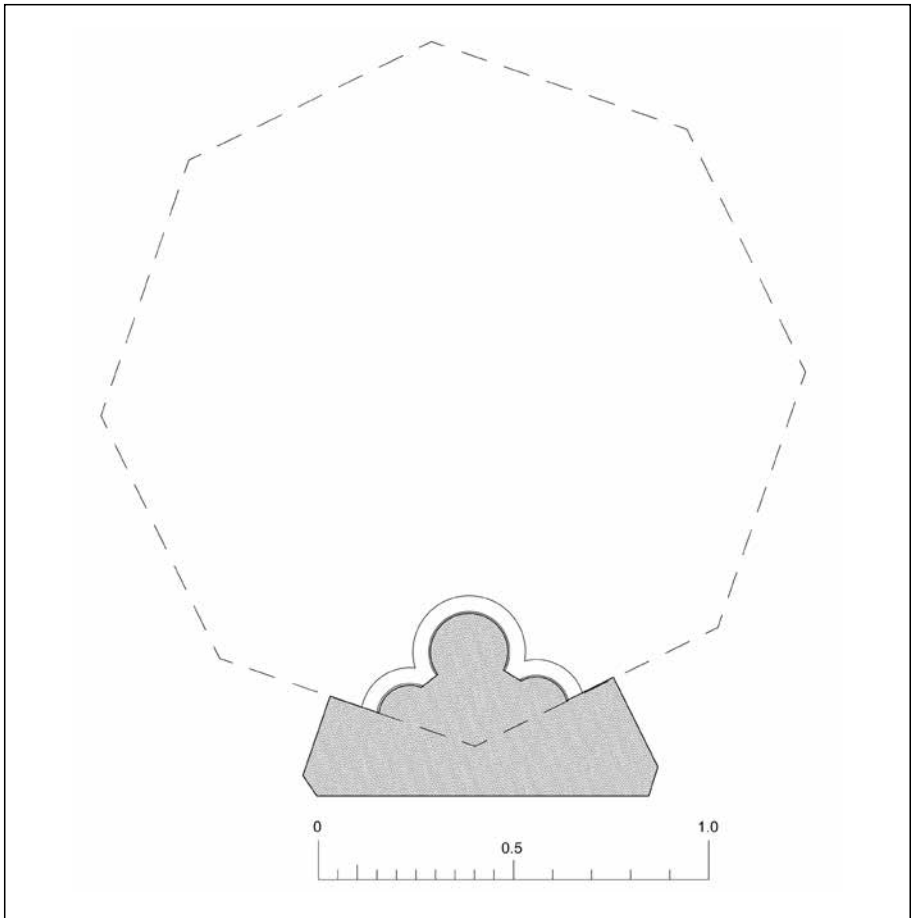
Grundrisszeichnung Dienstsockel im Chordachraum Ulmer Münster Nordseite.
